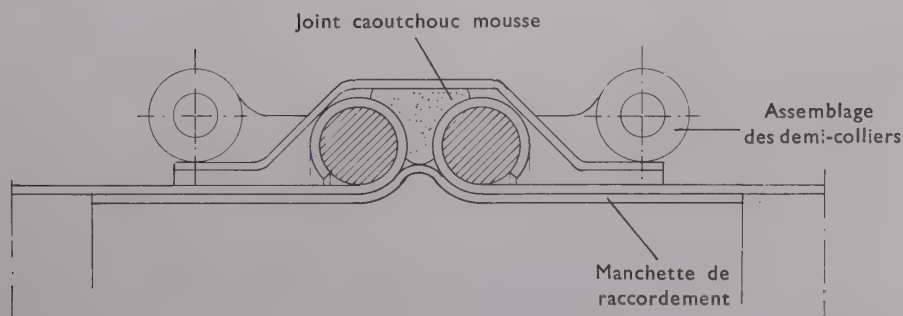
Joints d'assemblage pour tuyaux de ventilation
